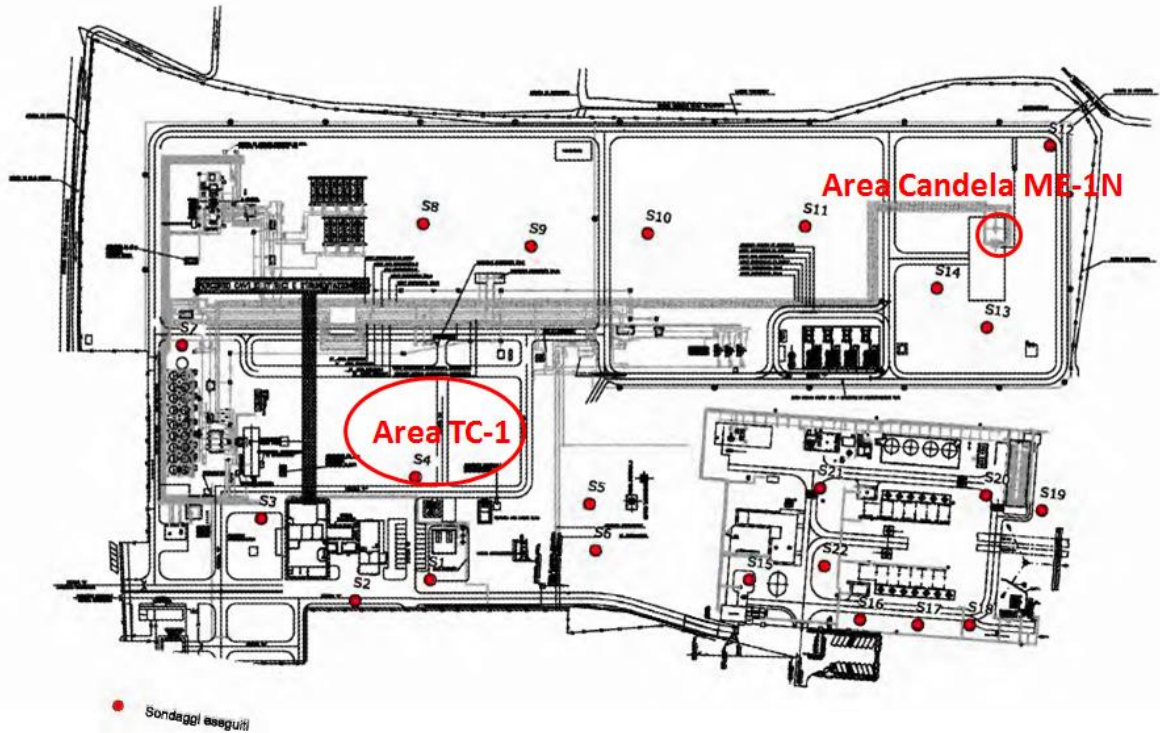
Centrale di Compressione STOGIT - Ubicazione dei Piezometri
